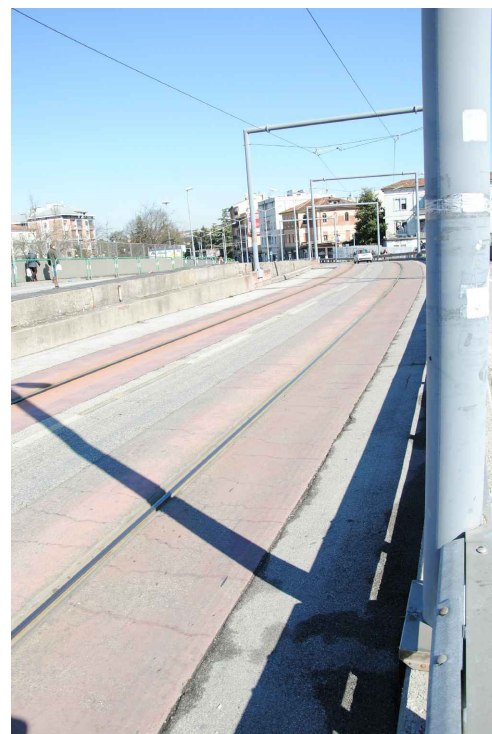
ristagno d'acqua tra la pista del tram e la pavimentazione bituminosa
